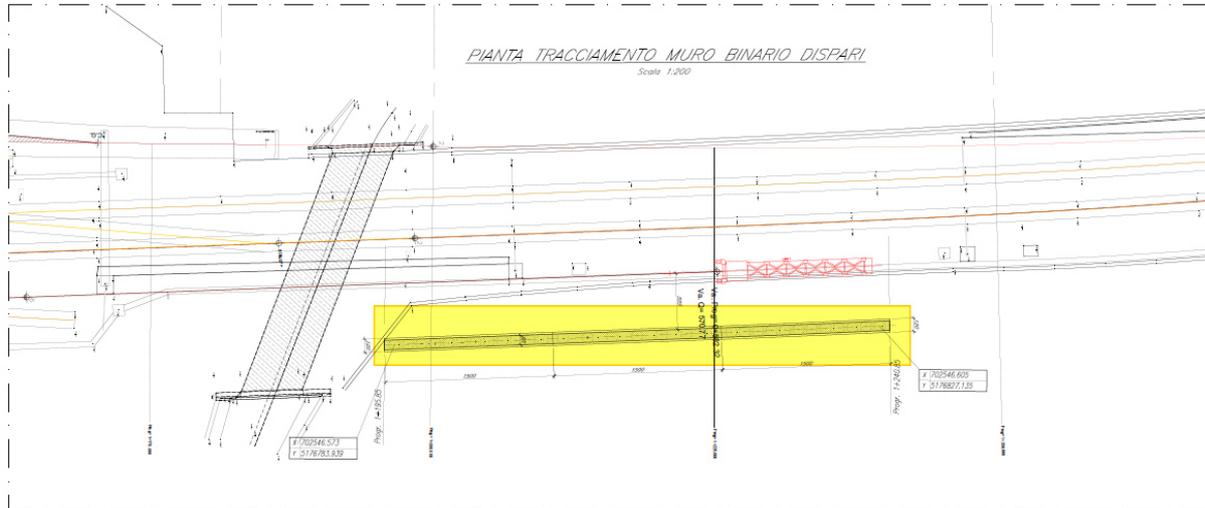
Individuazione Muro in c.a. su fondazioni profonde BD – Planimetria
